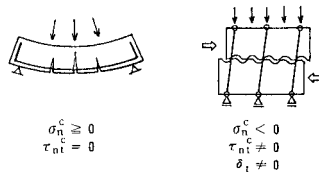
鉄筋コンクリート部材における2つのひびわれモードの例
